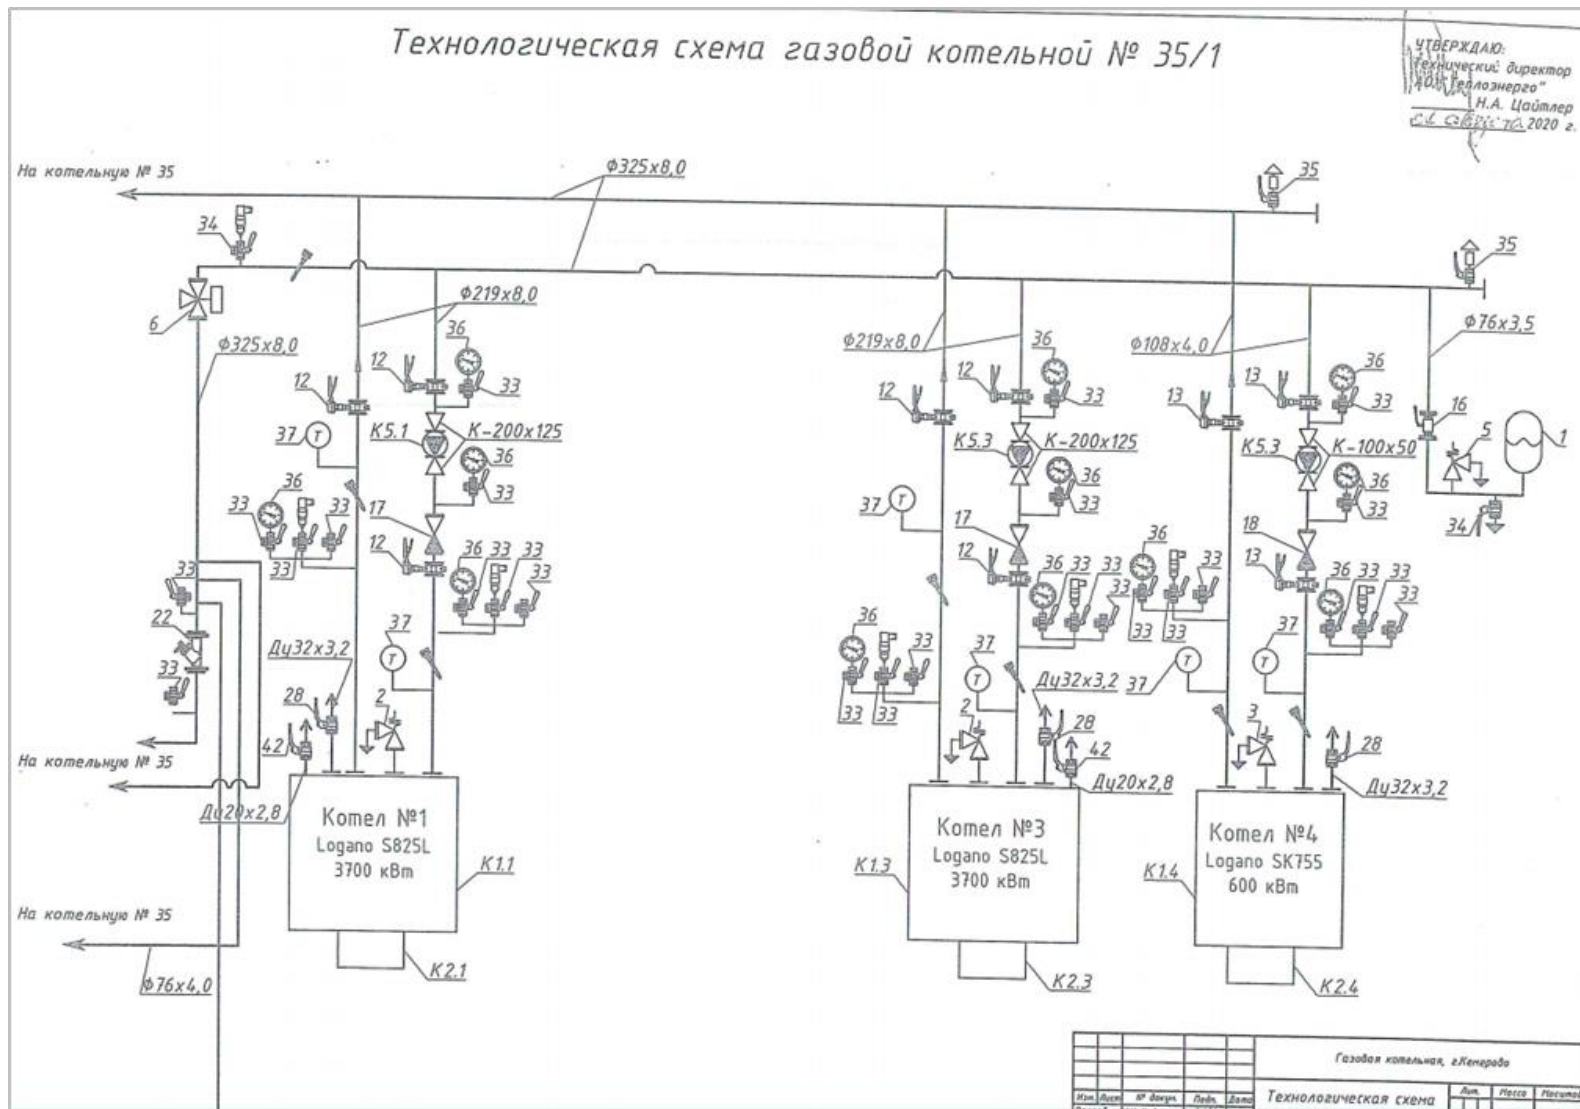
Тепловая схема Котельной № 35/1
